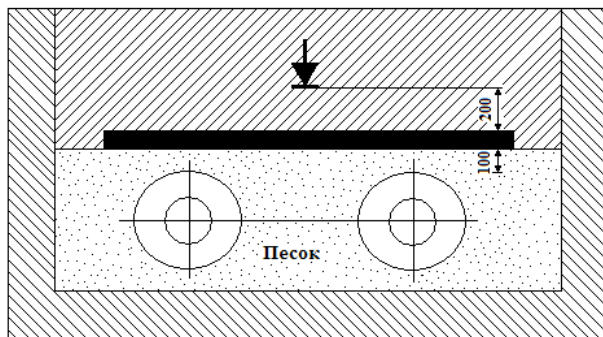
Установка бетонной армированной плиты над ПИ трубопроводом
